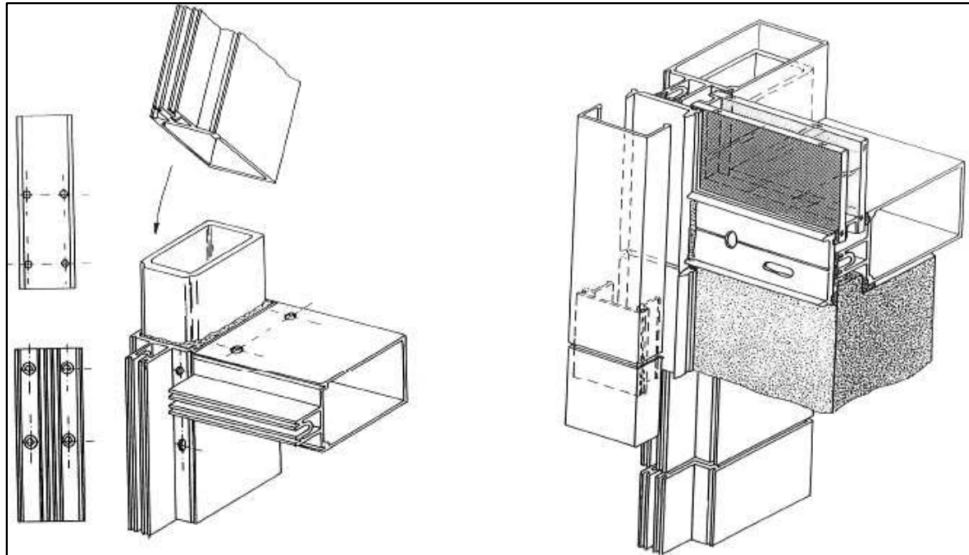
Unión deslizante de montantes. Fuente: Carpintería de aluminio – Juan C. Salvador.
